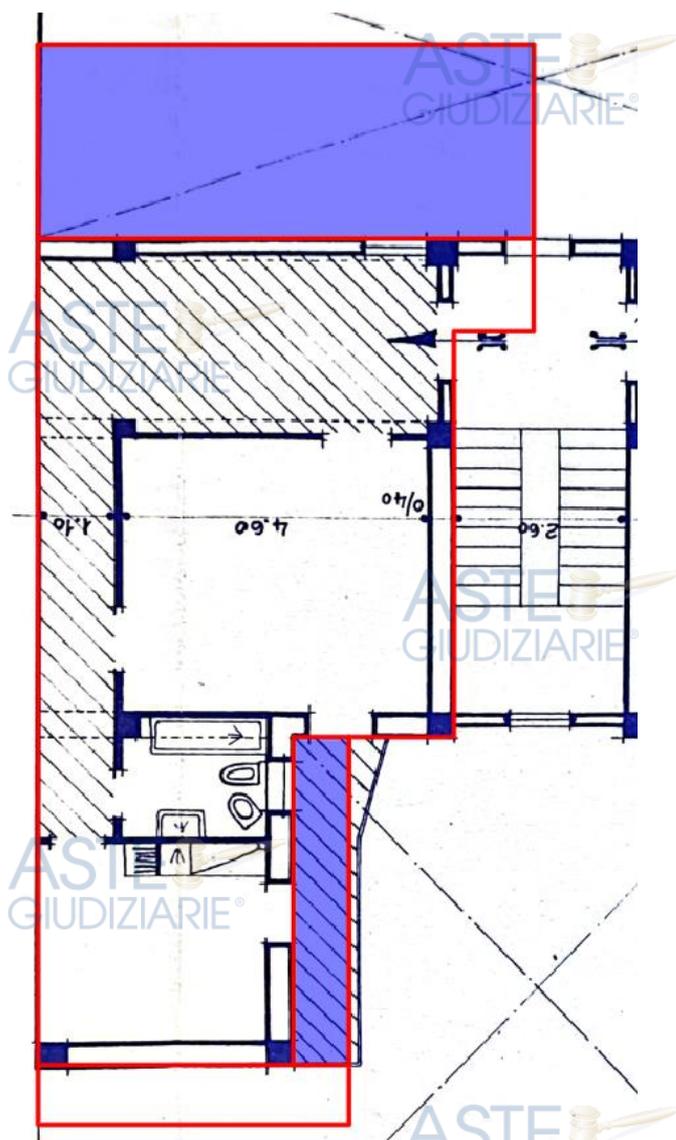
Sovrapposizione stato dei luoghi e planimetria concessionata
